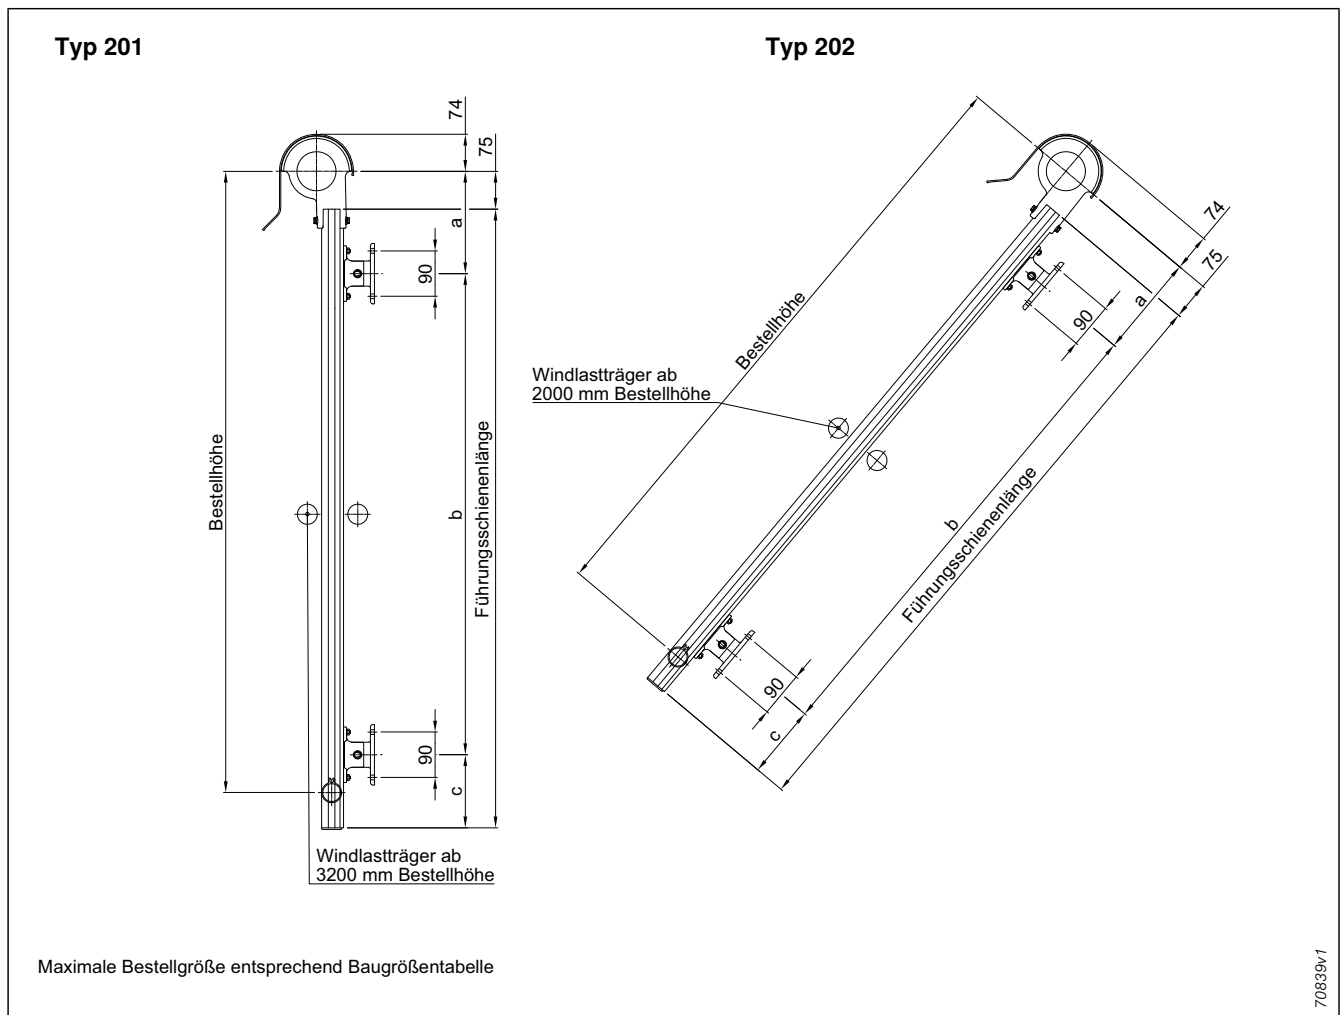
Führungsschienenhalter – Abstände Typen 201 und 202
